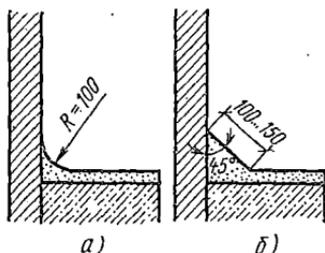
Примыкание стяжки к вертикальным конструкциям:
